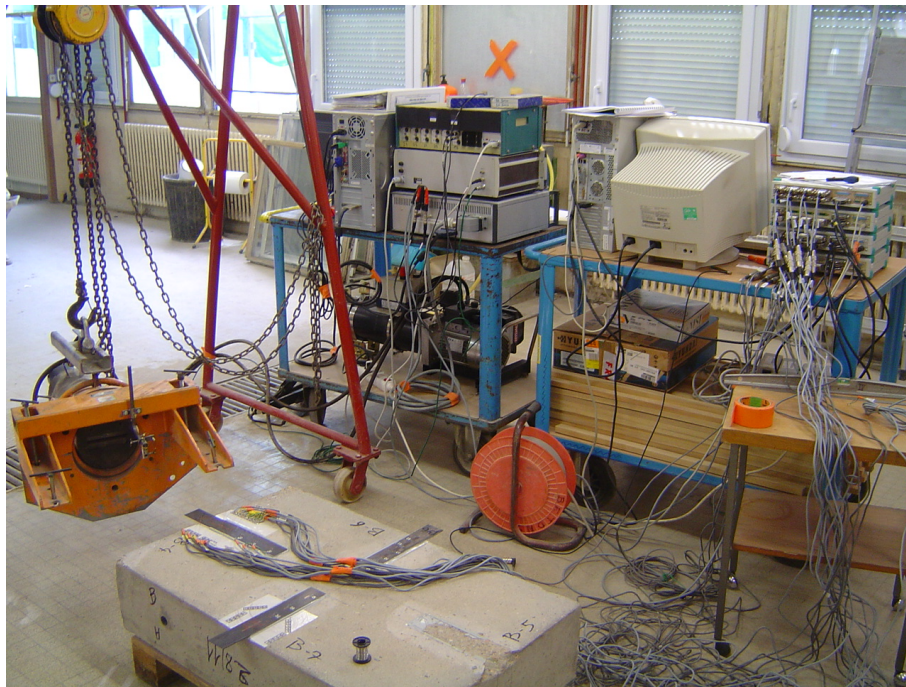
Photo du dispositif d'essai avec la machine de traction, le groupe hydraulique, le système de pilotage, et le système d'enregistrement des déformations
